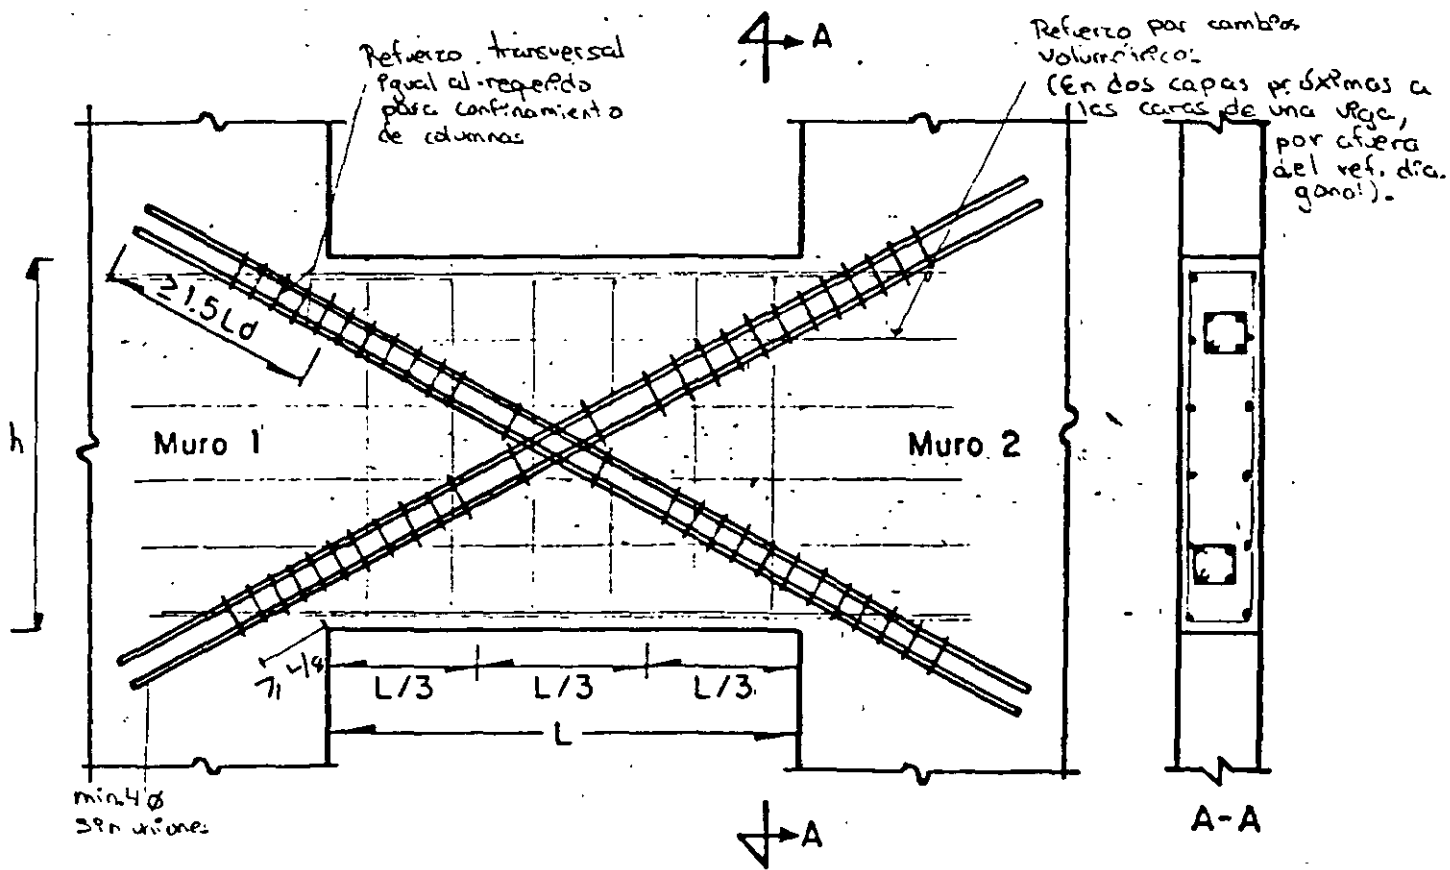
Refuerzo de viga de acoplamiento que une muros de
